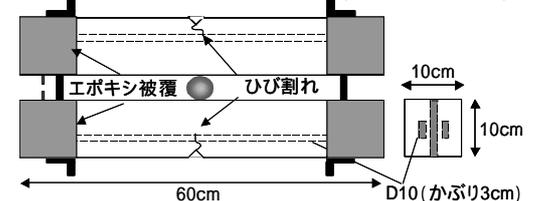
鉄筋腐食性検討供試体(ひび割れあり)
